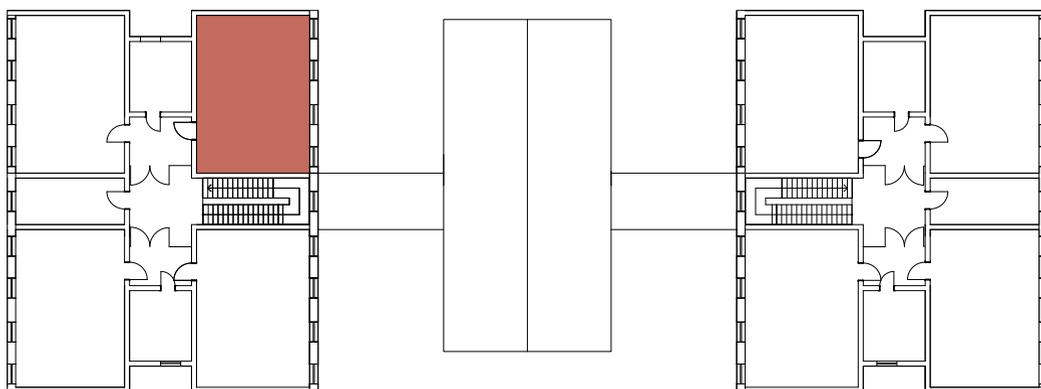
Grundriss Lage des Klassenzimmers im 3. Stock
